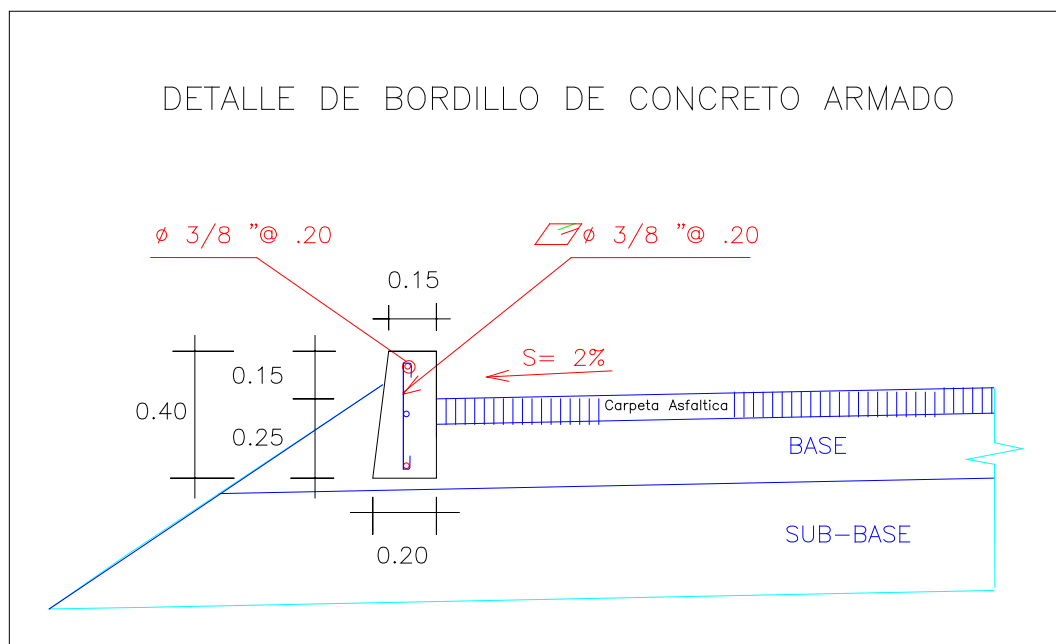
Detalle típico de bordillo de concreto armado
